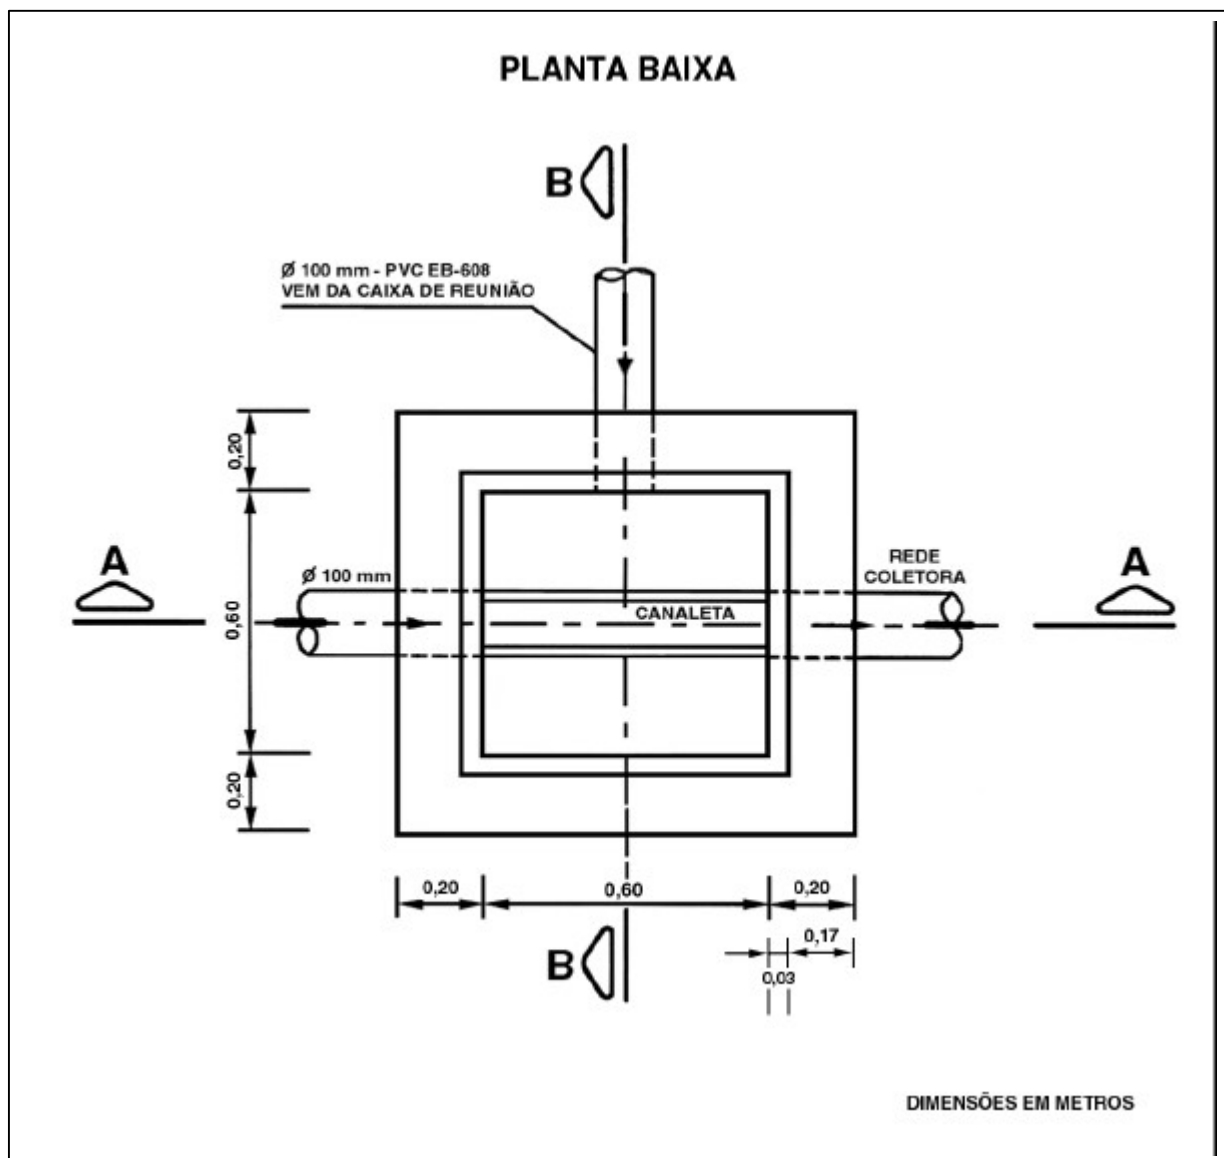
Caixa de Passagem CP 60- 100 – Planta Baixa
